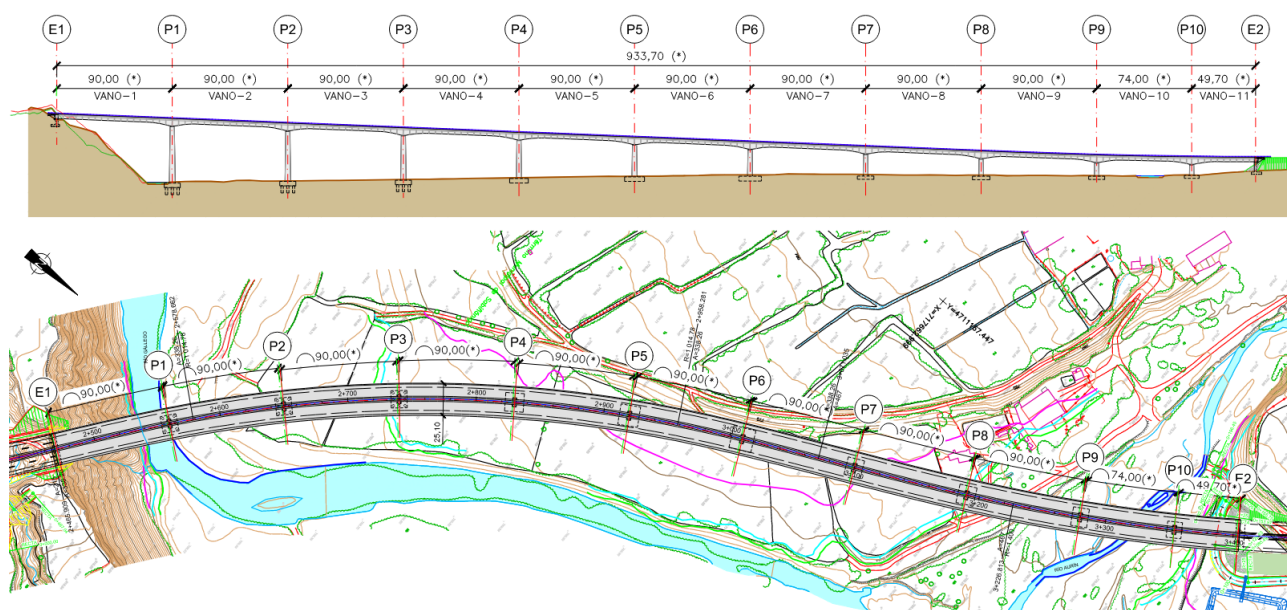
Alzado y planta del Viaducto de Sabiñánigo ejecutado mediante cimbra autolanzable con vanos tipo de 90 m
